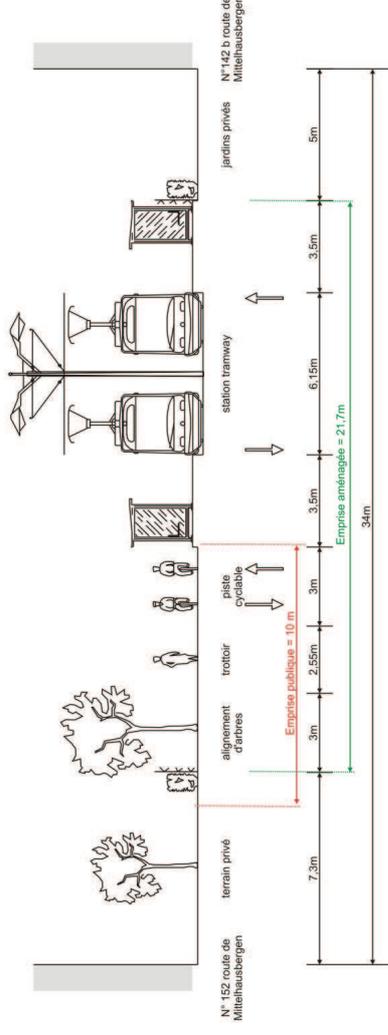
Situation projetée coupe 7 Parc de la Bergerie
